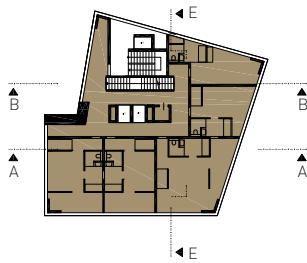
Grundriss Funktionen 5.0G +23,35m
